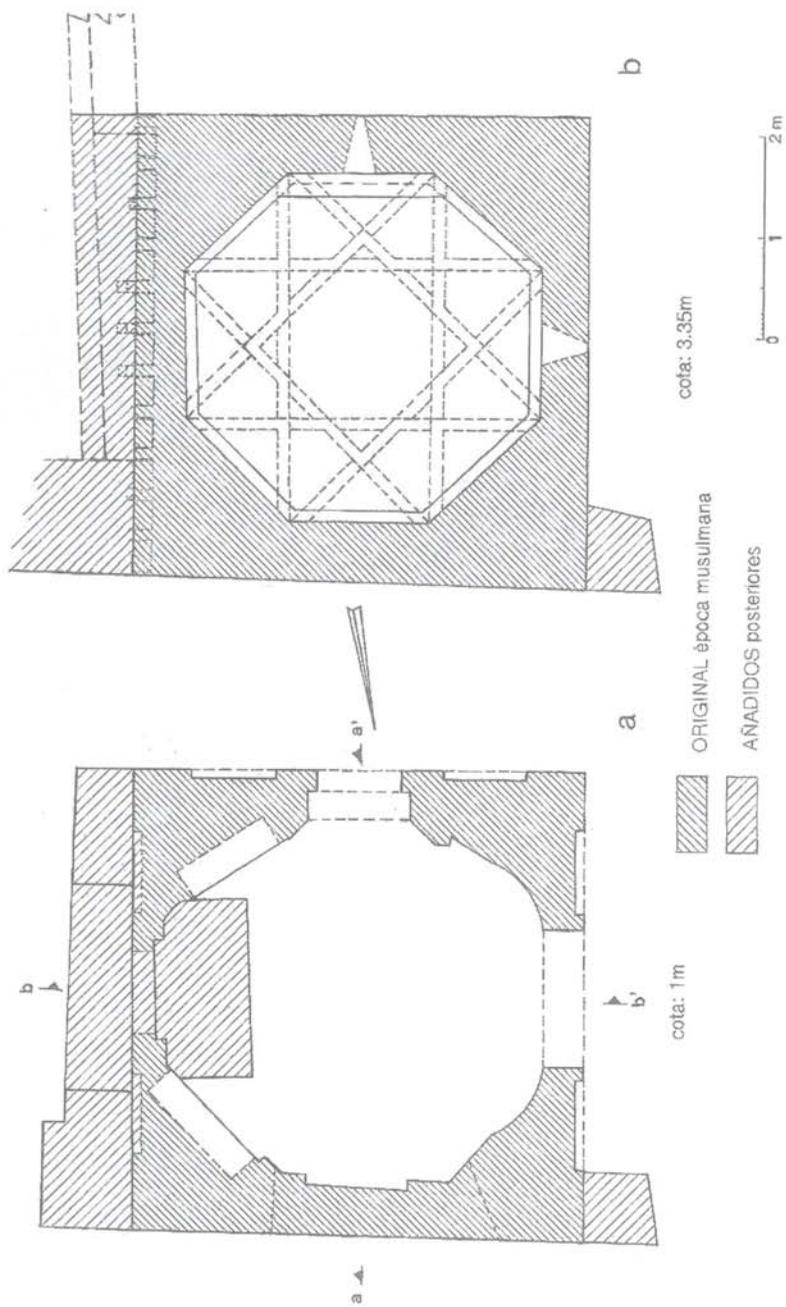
Capilla de Belén, Convento de Santa Fe, Toledo. a Planta del oratorio, cota 1 m.; b planta a la altura.
